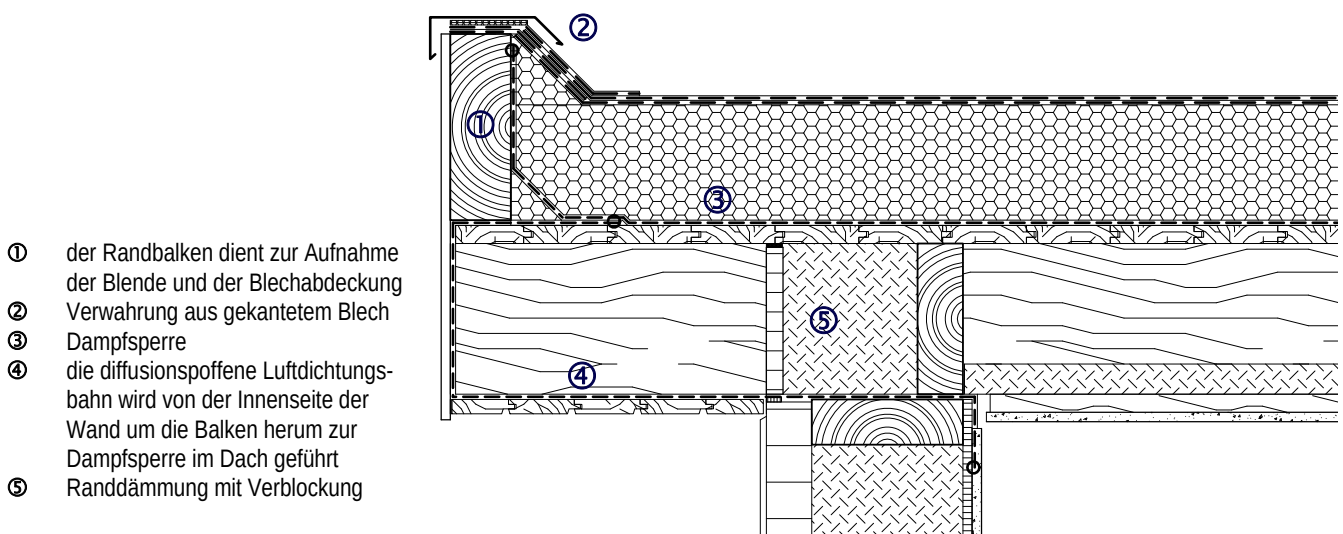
Für ein Flachdach mit aufliegender Dämmung wird hier der Dachüberstand mit auskragender Balkenlage dargestellt. Die Dachkante wirkt durch die große Höhe sehr massiv.
